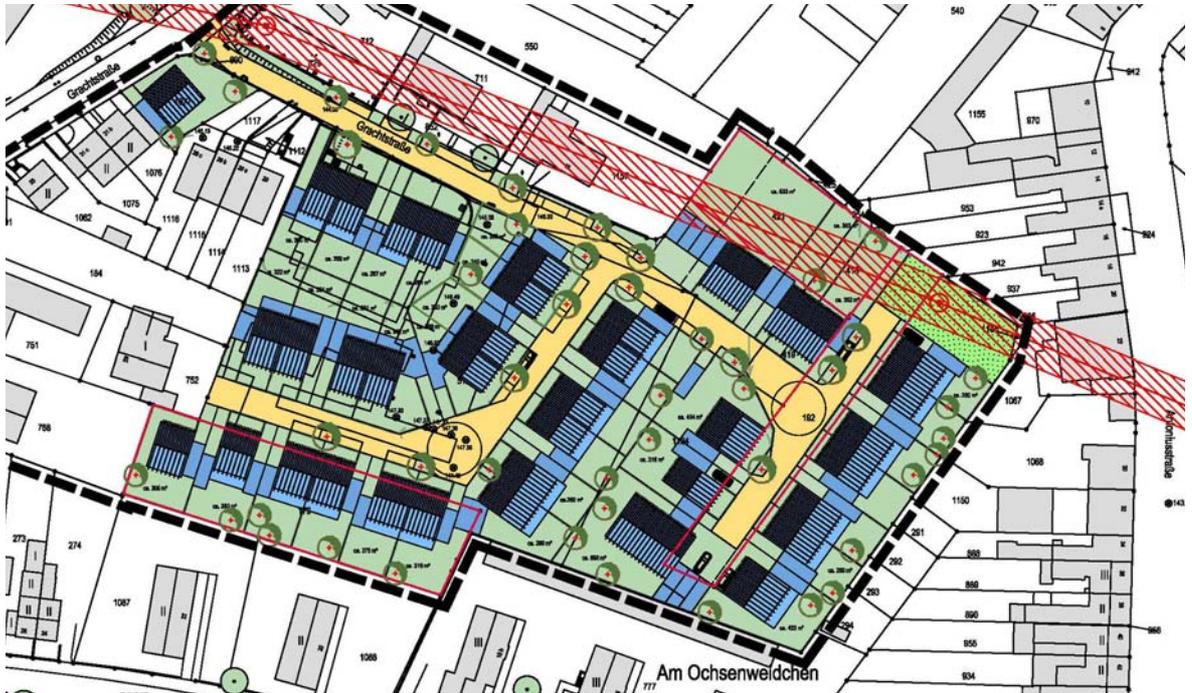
Entwurfsvariante II, dargestellt sind 5 EH, 30 DHH und 2 MFH
